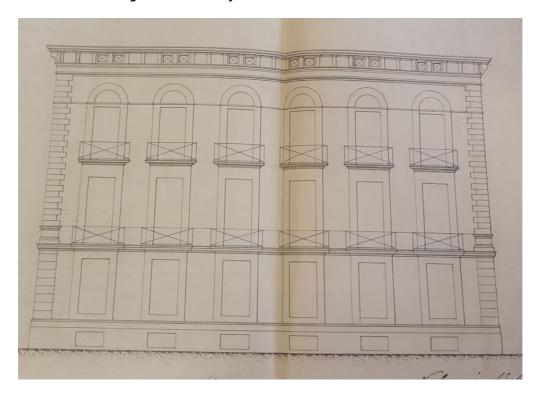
Planos de la fachada. Fuente: Archivo histórico
